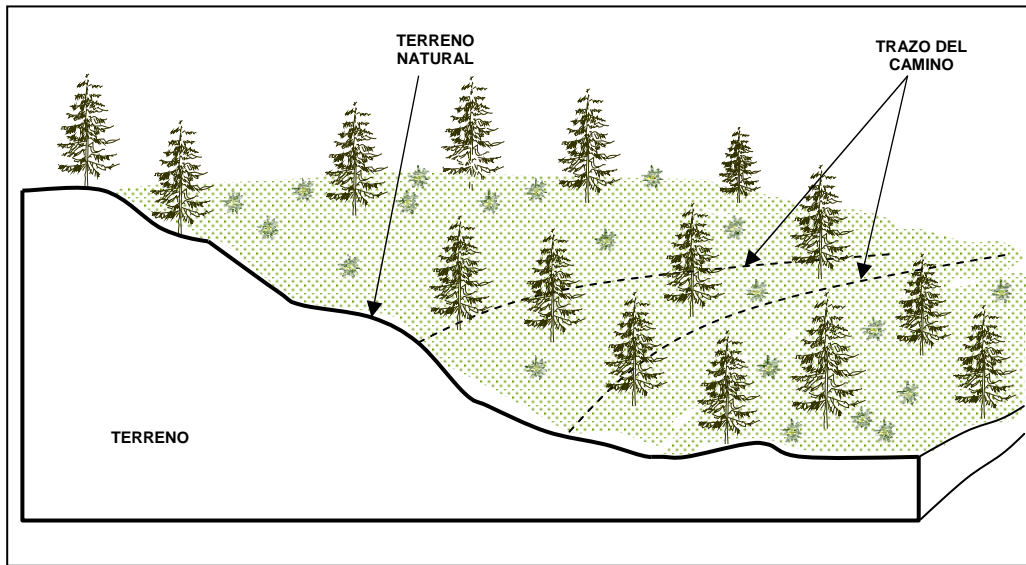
TRAZO DEL CAMINO SOBRE EL TERRENO NATURAL PARA POSTERIORMENTE HACER CORTES Y CONSTRUIR TERRAPLENES
